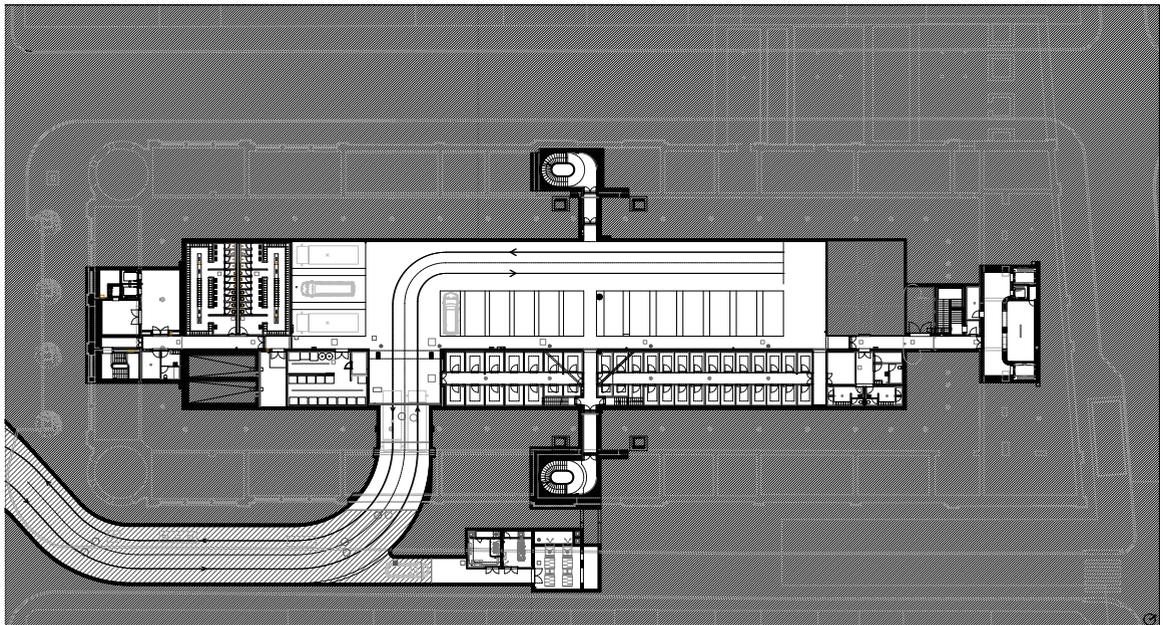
Planta de implantação com marcação do túnel de acesso à cave logística (desenho de projecto).
